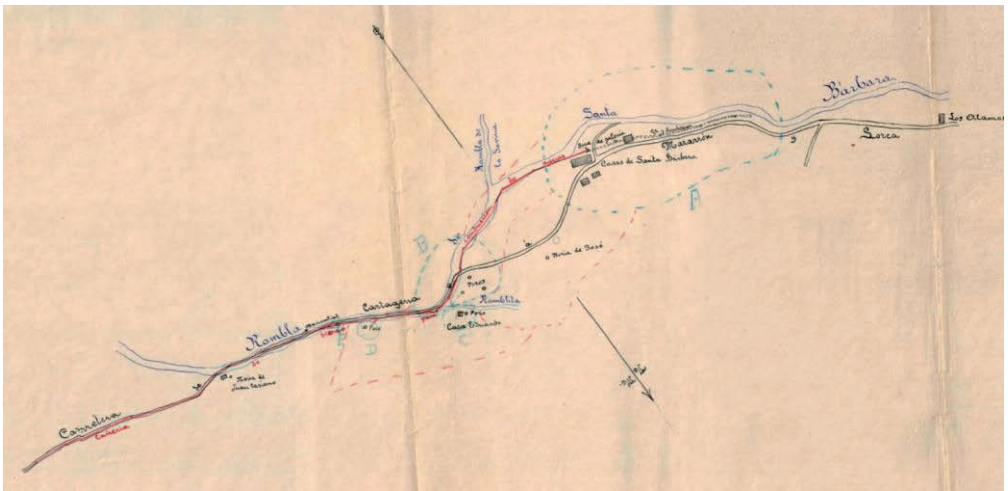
Plano de la captación y la cañería de transporte en la rambla de Santa Bárbara (Fuente: Archivo del Ministerio de Fomento)
